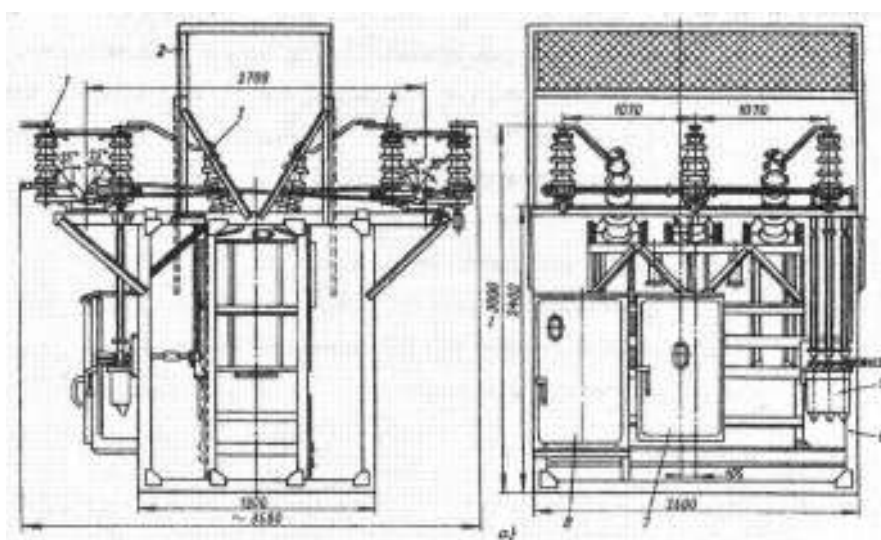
Крупноблочное ОРУ-35. Блок выключателя: 1– разъединитель линейный; 2 – ремонтное ограждение; 3 – выключатель; 4 – разъединитель шинный; 5 – привод разъединителей; 6 – металлоконструкция; 7 – шкаф привода выключателя; 8 – релейный шкаф
